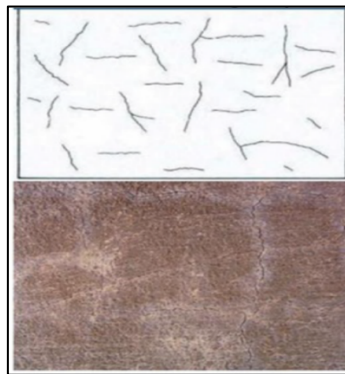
Fisuración del hormigón por retracción plástica
